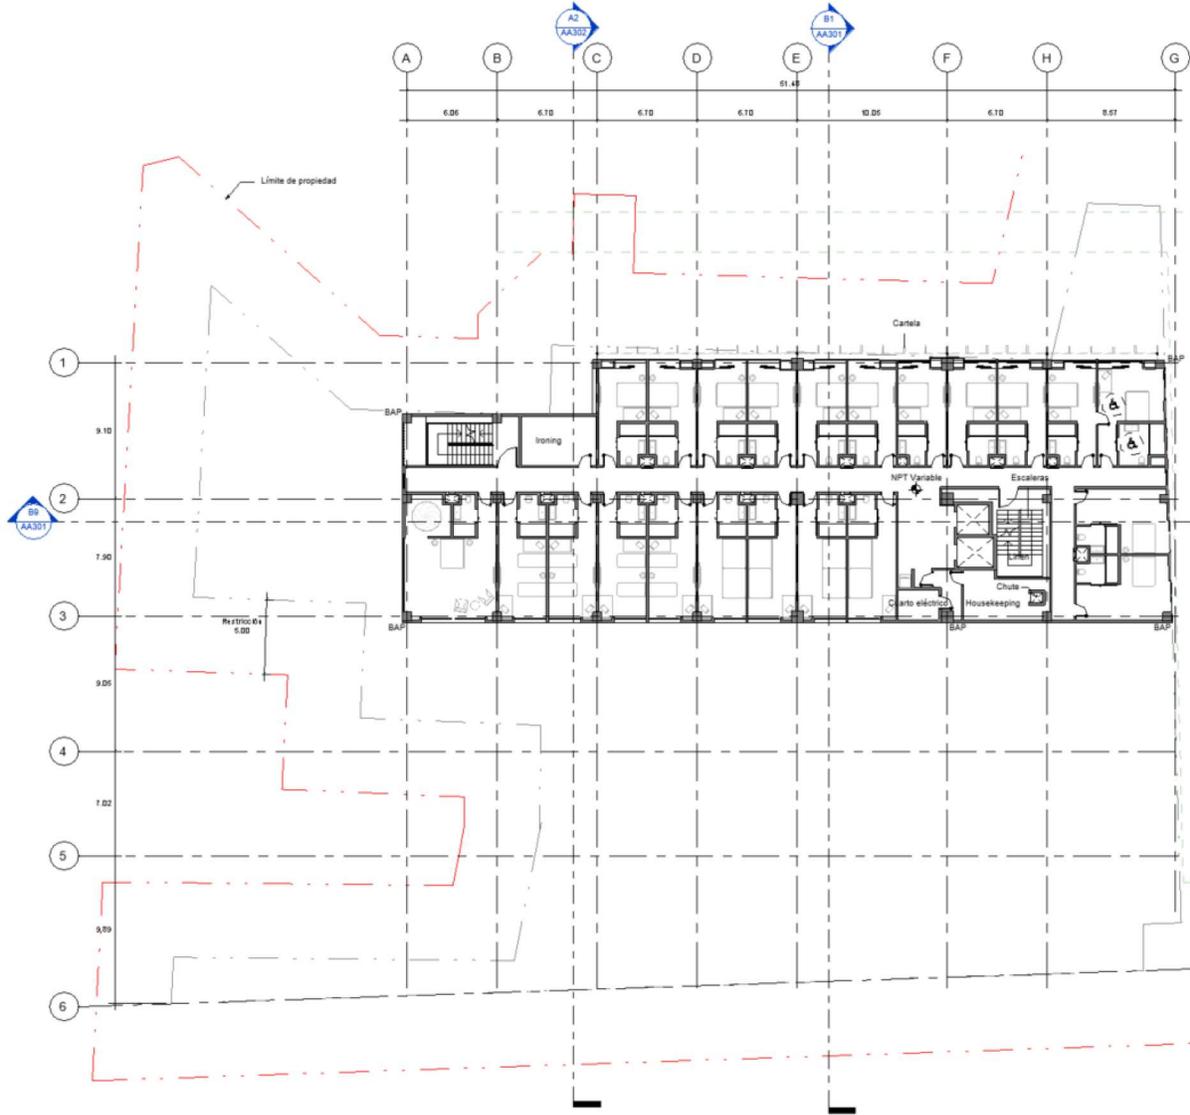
Planta arquitectónica, séptimo y octavo nivel.
